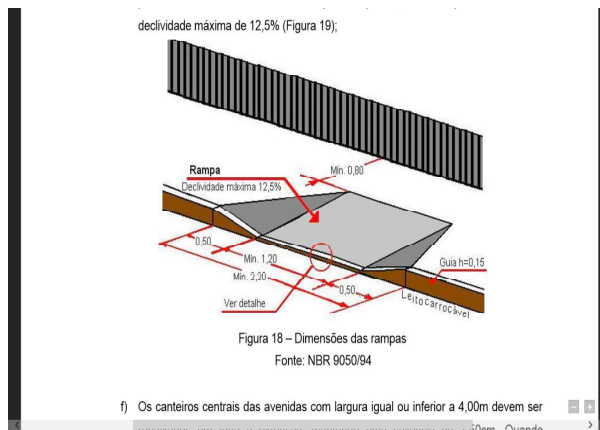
Dimensões das rampas. Fonte: NBR 9050/2004
